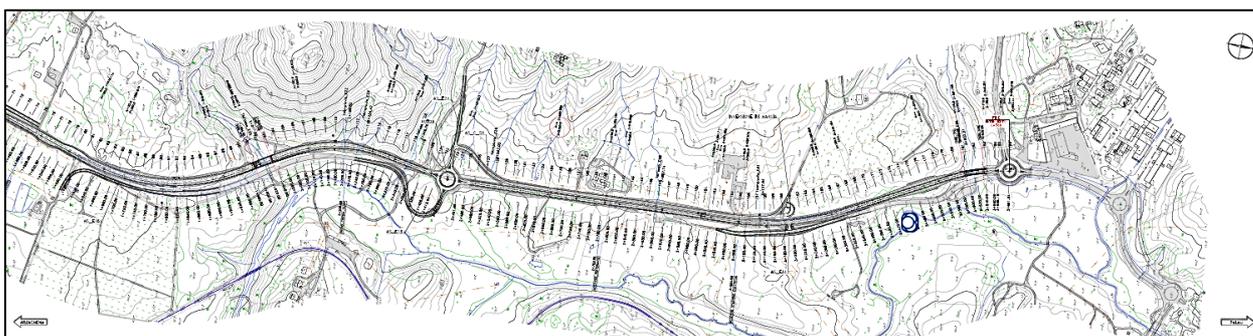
Asse CA366\_AP02 - Tratto ROT03 - Rotatoria Palau
